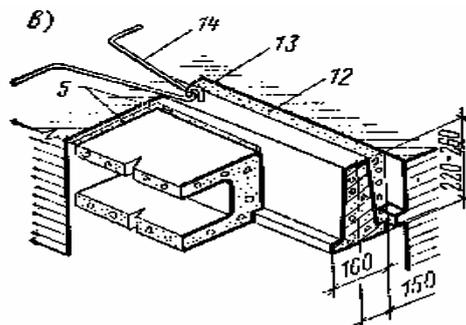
Перекрытие по железобетонным балкам (анкерка):
